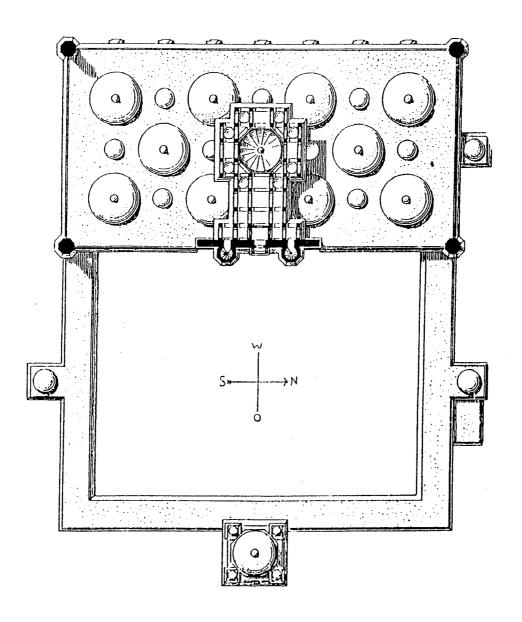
مسقط أفقي لجامع سوسه (خوزستان) . (عن ، كريزول) .
